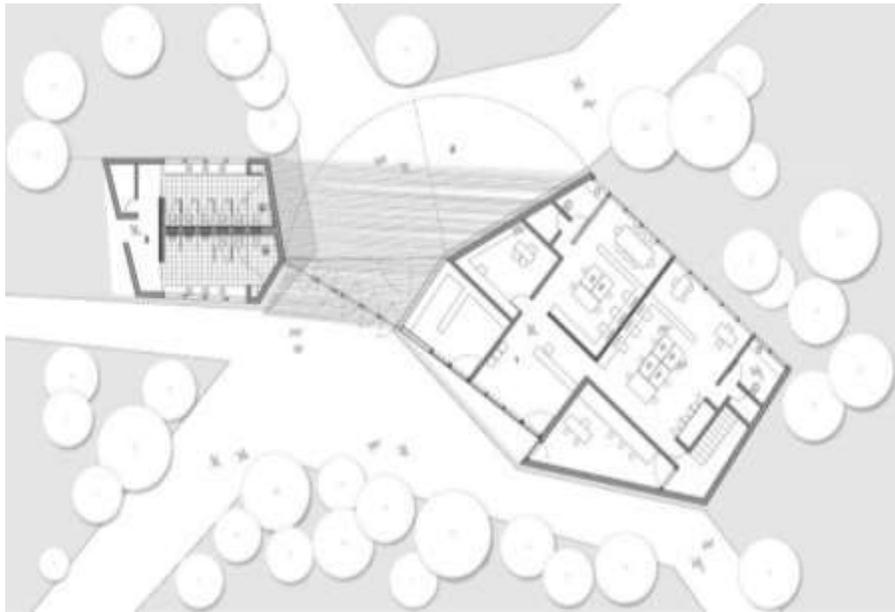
planta arquitectónica, tomada de [www.Archdaily.mx](http://www.Archdaily.mx), el 23/10/17, edición propia
